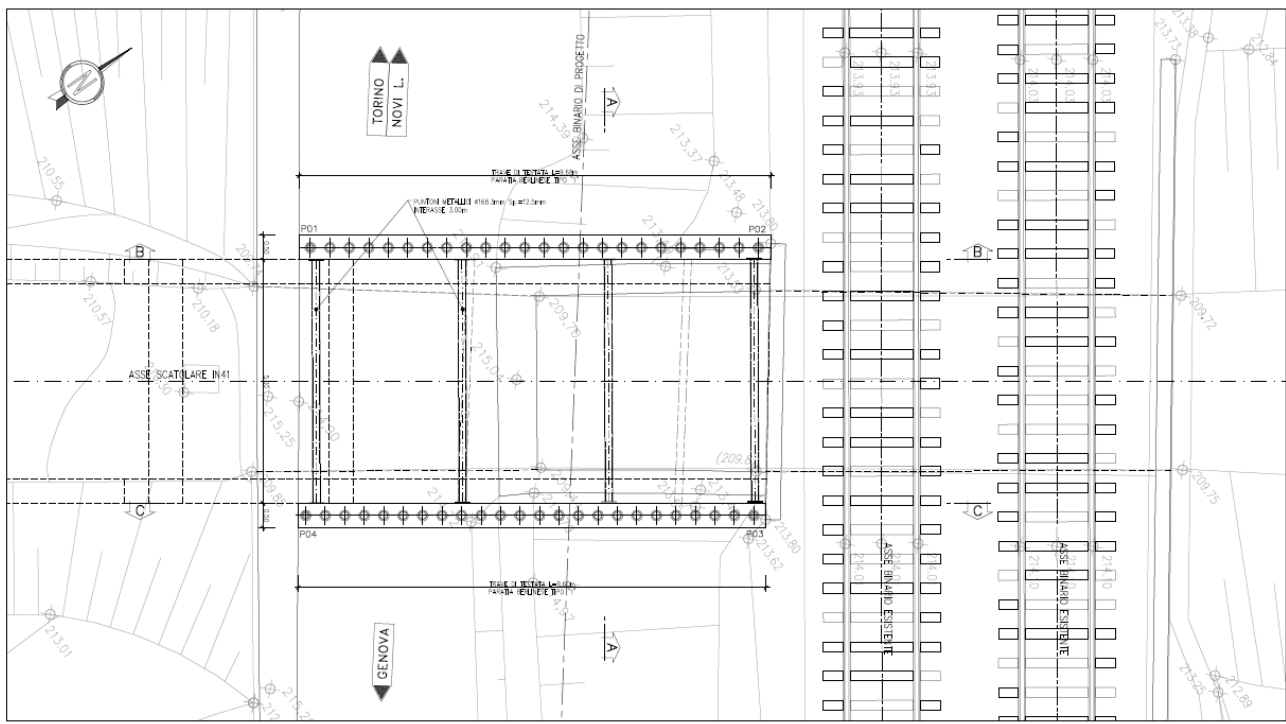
Planimetria delle opere provvisionali e del sistema di contrasto
